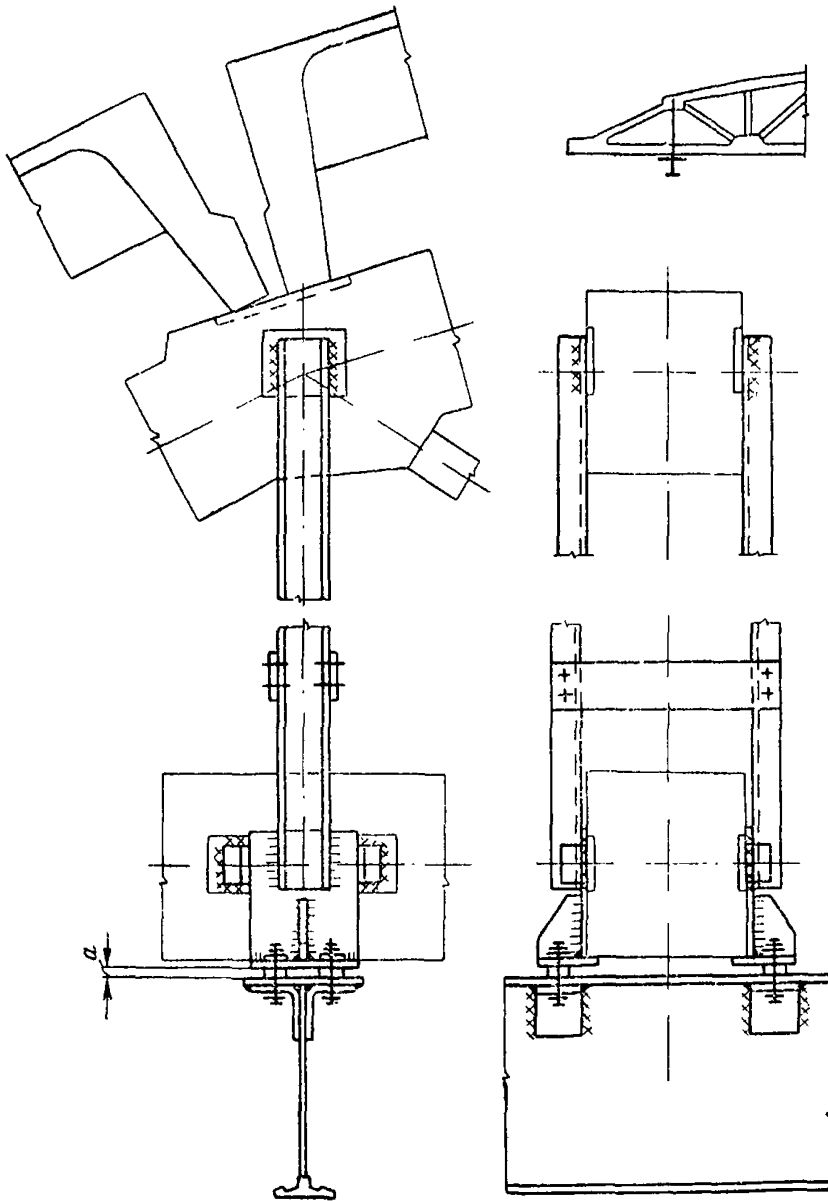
Подвеска балки в верхнем узле железобетонной фермы на закладных деталях
